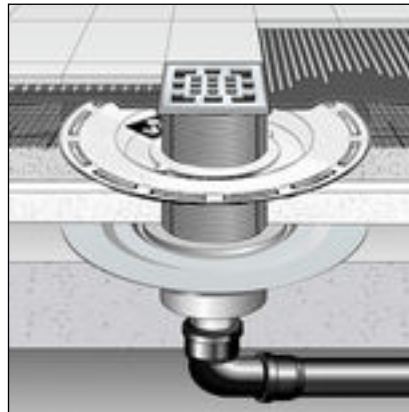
Schema einer Verbundabdichtung mit Aufstockelement
